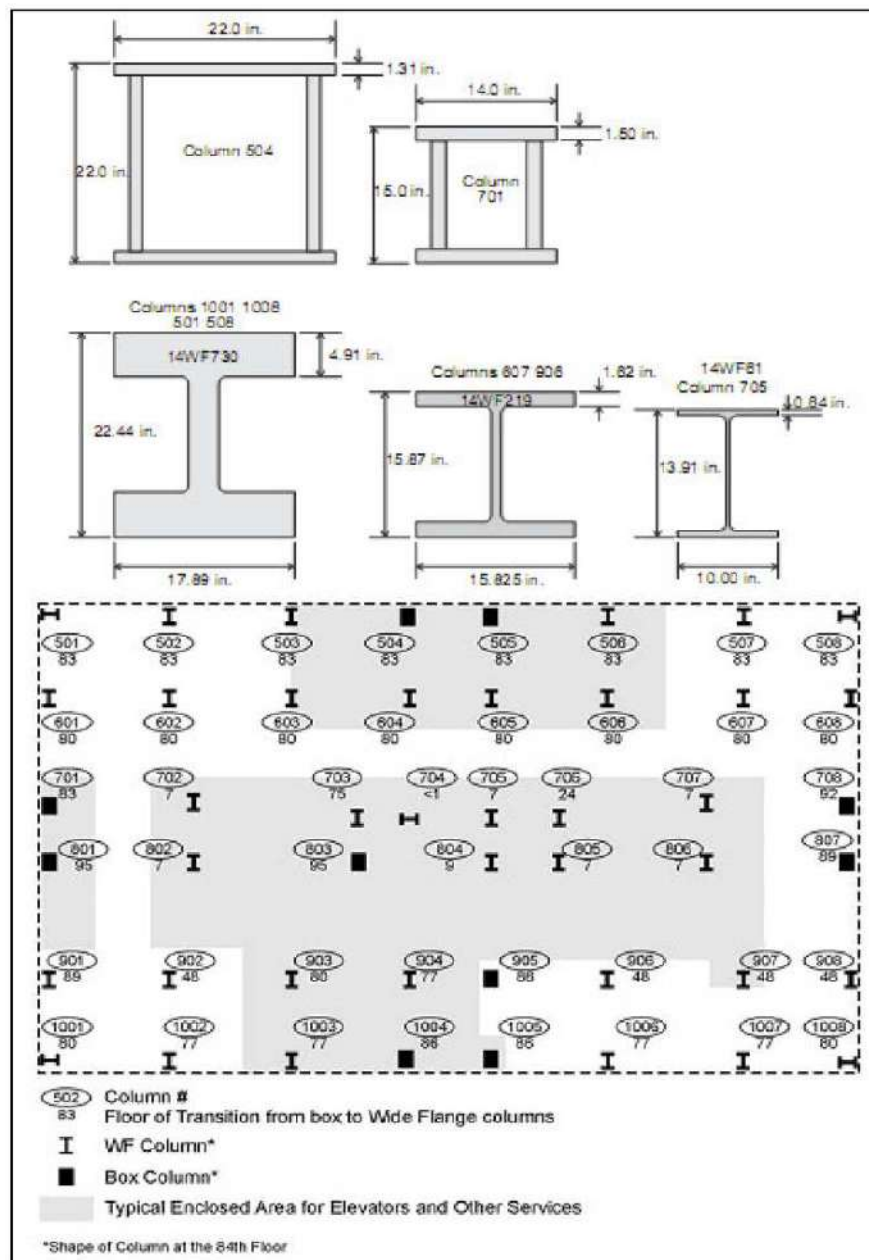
sezioni utilizzate nella realizzazione delle Torri Gemelle, in un piano di transizione tipo.
